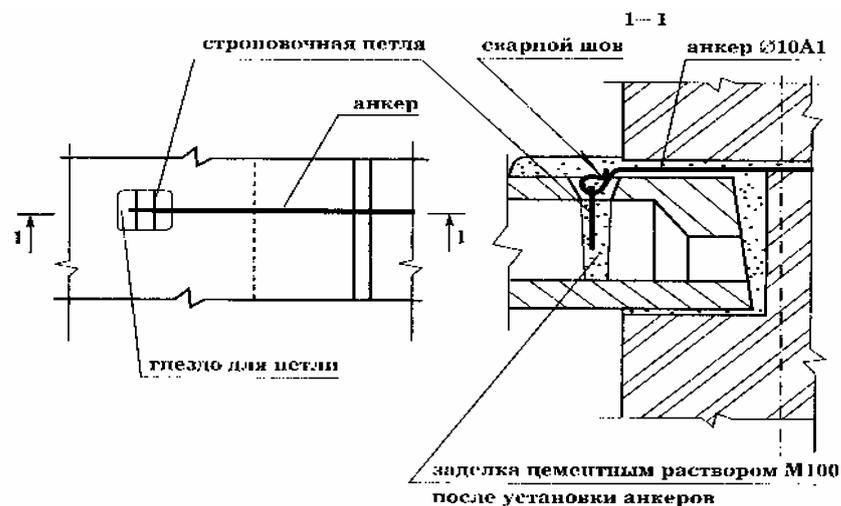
Анкеровка плит перекрытий с утепленными петлями
